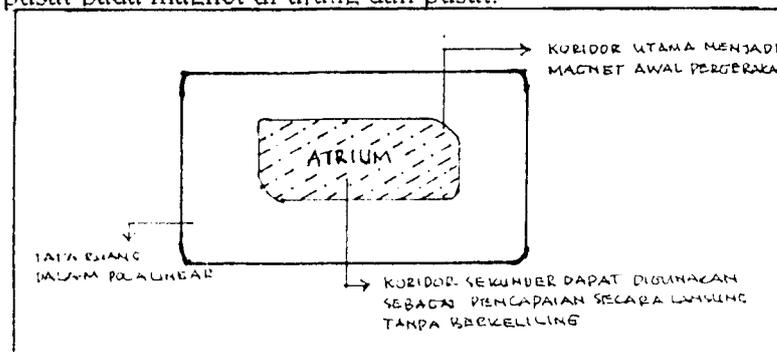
Skema ruang dalam Bangunan renovasi Shopping Center Pasar Beringharjo
